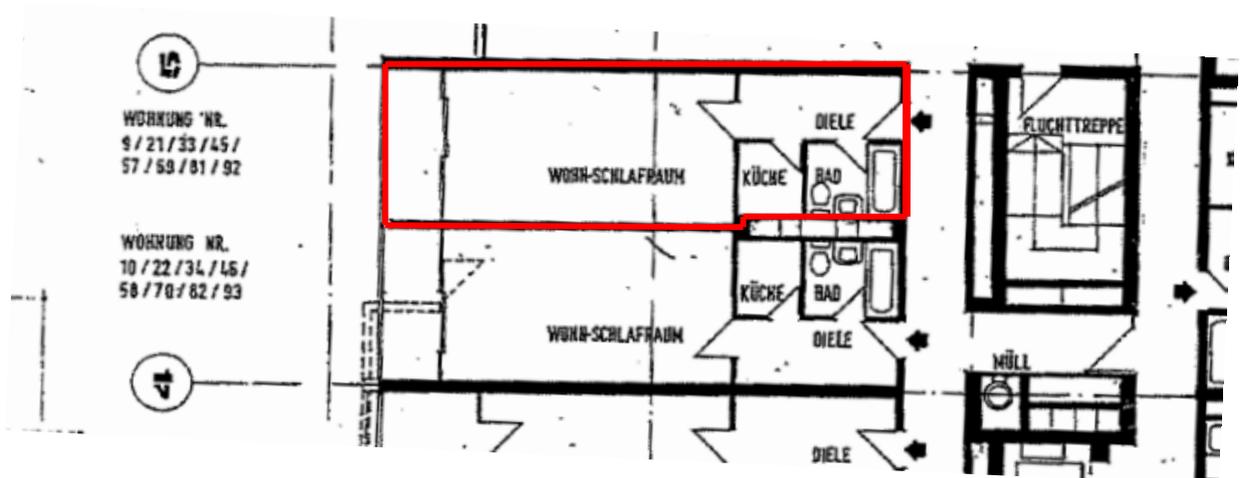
Grundriss (gemäß Teilungserklärung)
